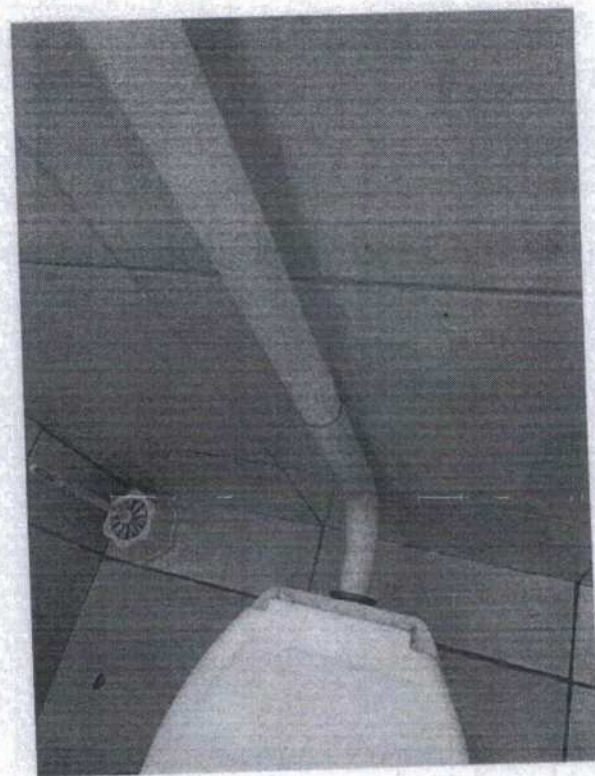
Vista do banheiro da Unidade Básica de Saúde Espraiado
